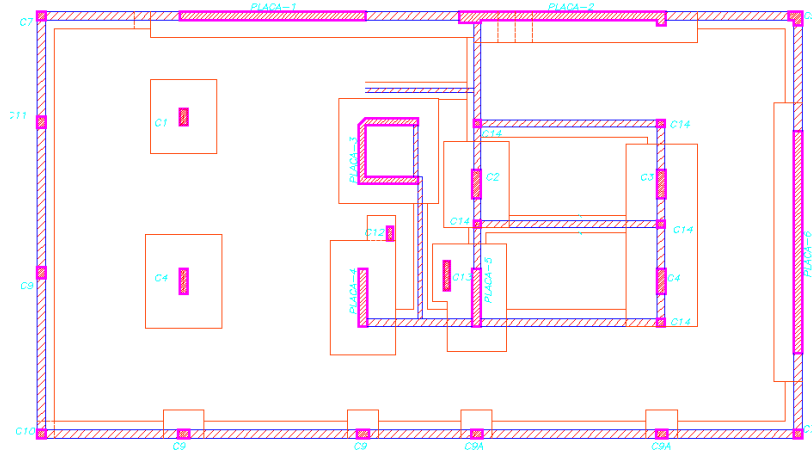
Ubicación de Elementos Estructurales - Placas, Columnas, Muros de Contención.
